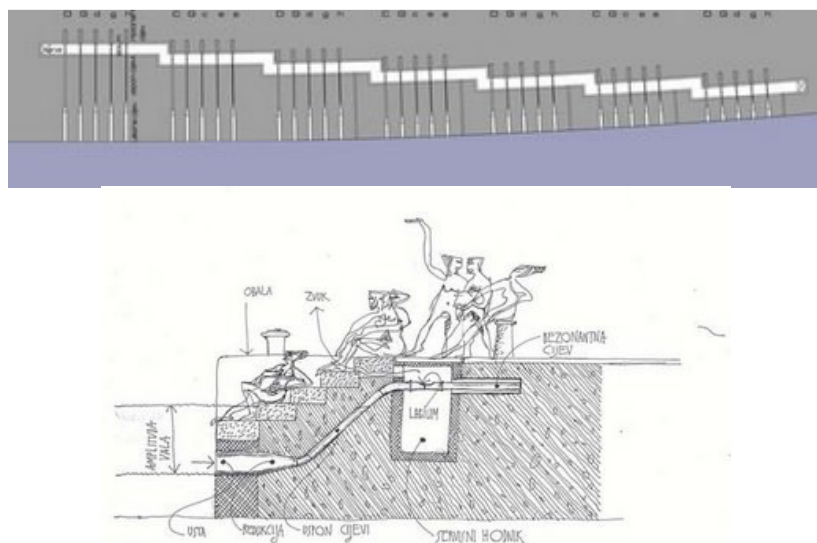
Planta y sección del órgano de mar de Zadar
